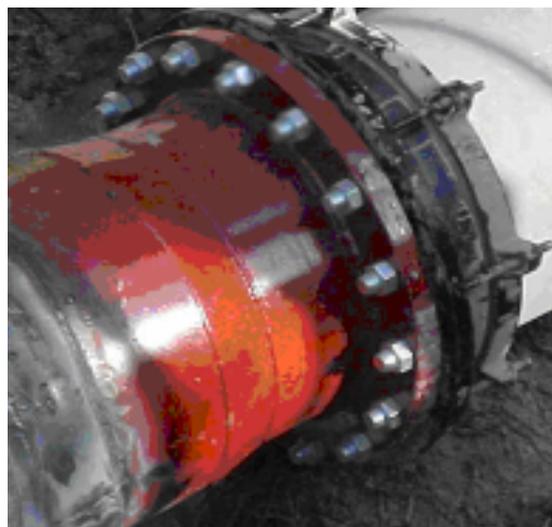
Cabo extremo con brida soldado a la tubería de acero
